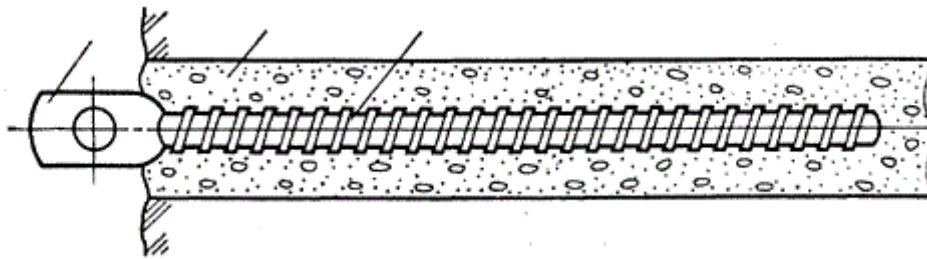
Конструкция железобетонного анкера: 1 – стержень из арматурной стали; 2 – цементный раствор; 3 – хвостовик с проушиной для крепления сетки
